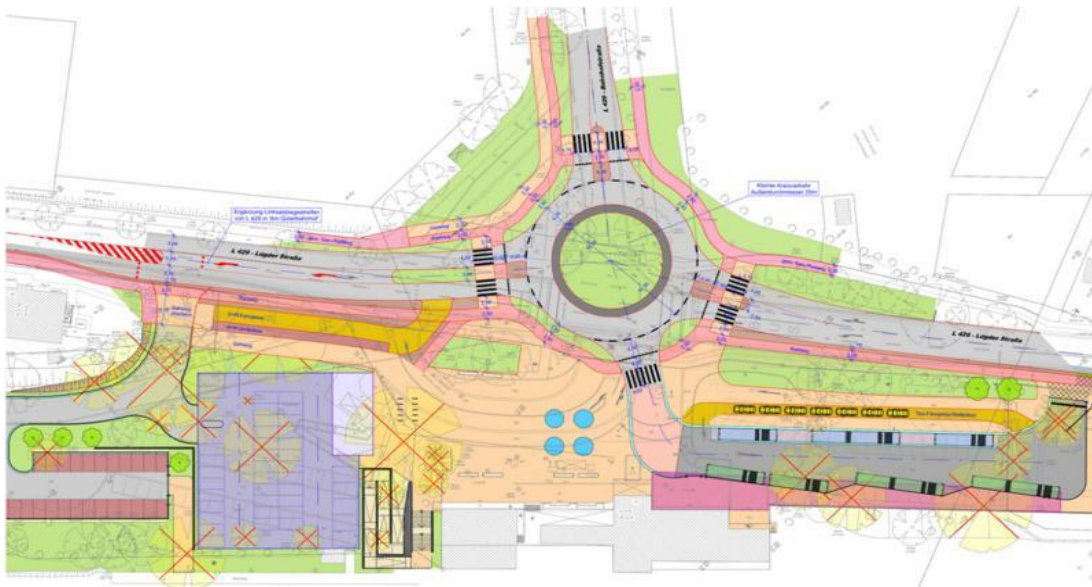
Lageplan Variante 4 zum Knotenpunkt L426 / L429 / ZOB-Zufahrt
